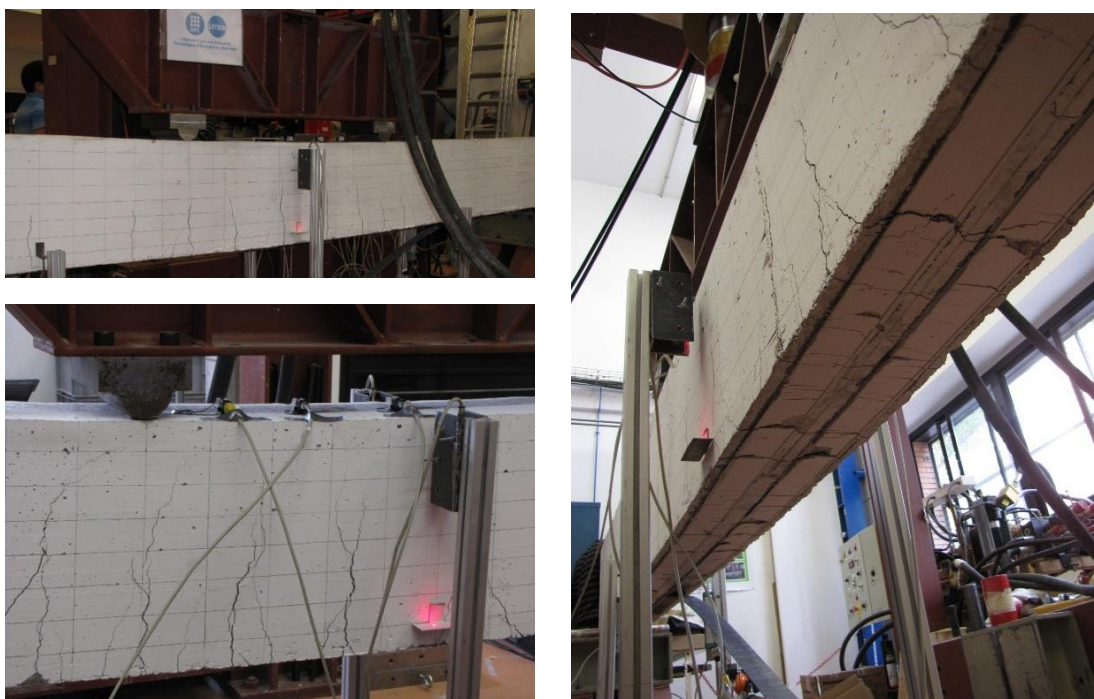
b) Tipo de falla en ensayo de viga CG05 (detalle)
